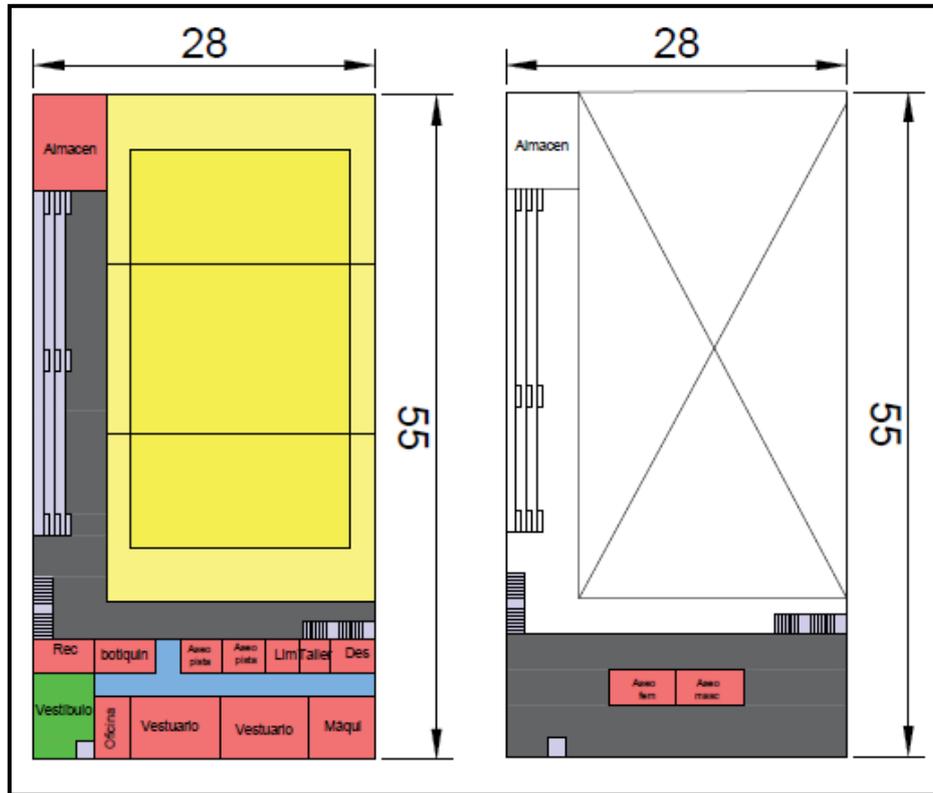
Distribución de los espacios de la alternativa 2. Planta baja (izquierda) y Planta 1 (derecha). (Fuente: Elaboración propia).
